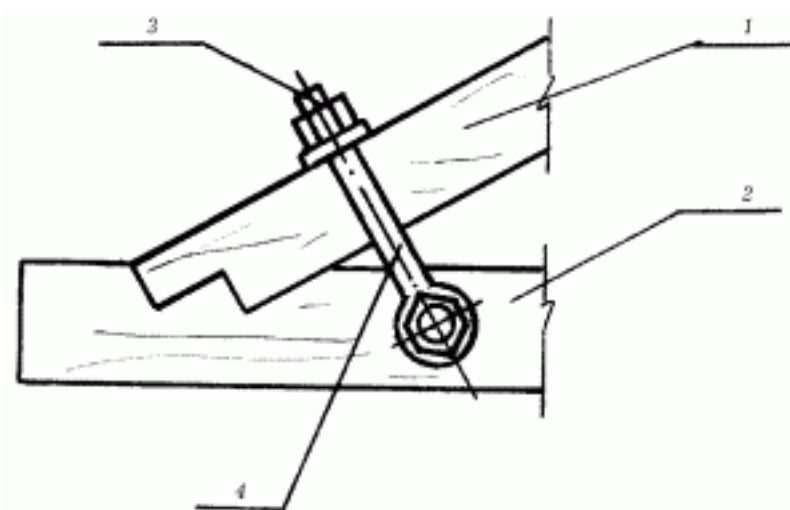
Соединение стропил болтом и хомутом: 1 – стропильная нога; 2 – затяжка; 3 – болт; 4 – хомут.
